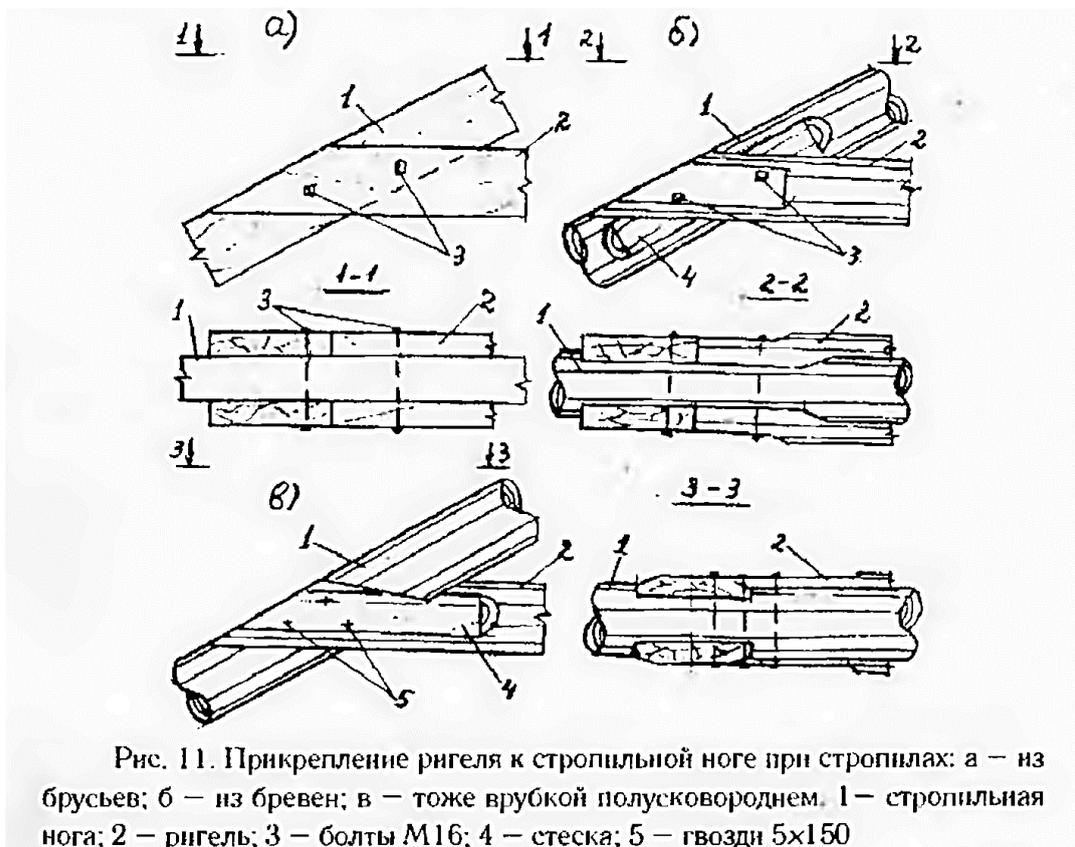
Прикрепление ригеля к стропильной ноге при стропилах: а – из брусев; б – из бревен; в – тоже врубкой полусковороднем. 1 – стропильная нога; 2 – ригель; 3 – болты М16; 4 – стеска; 5 – гвозди 5x150
